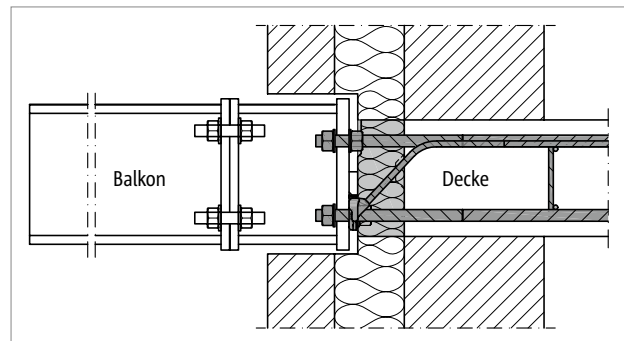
Schöck Isokorb® T Typ SKP: Dämmkörper innerhalb der Kerndämmung; bauseitiges Verbindungsstück zwischen dem Isokorb® und dem Balkon schafft Flexibilität im Bauablauf
